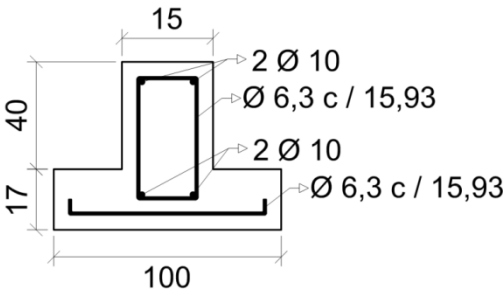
Detalhe da seção transversal de uma sapata corrida com viga de rigidez.
